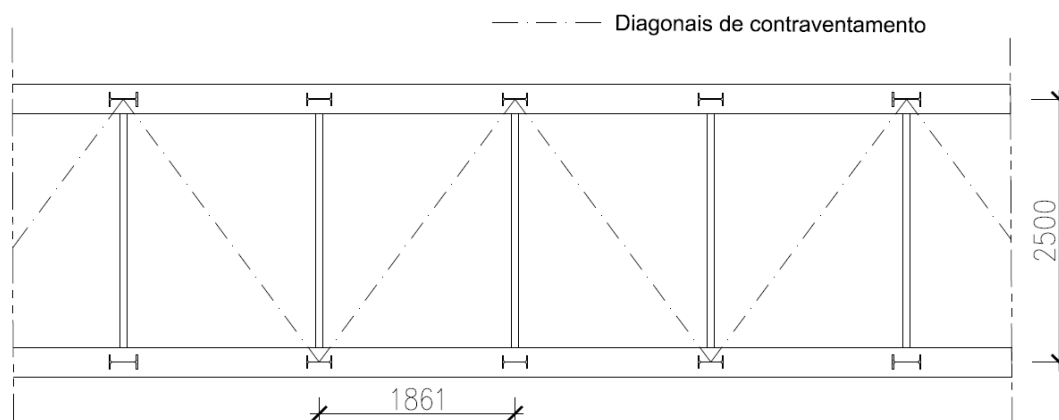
Corte em planta da estrutura metálica do tabuleiro nas zonas a meio vão
